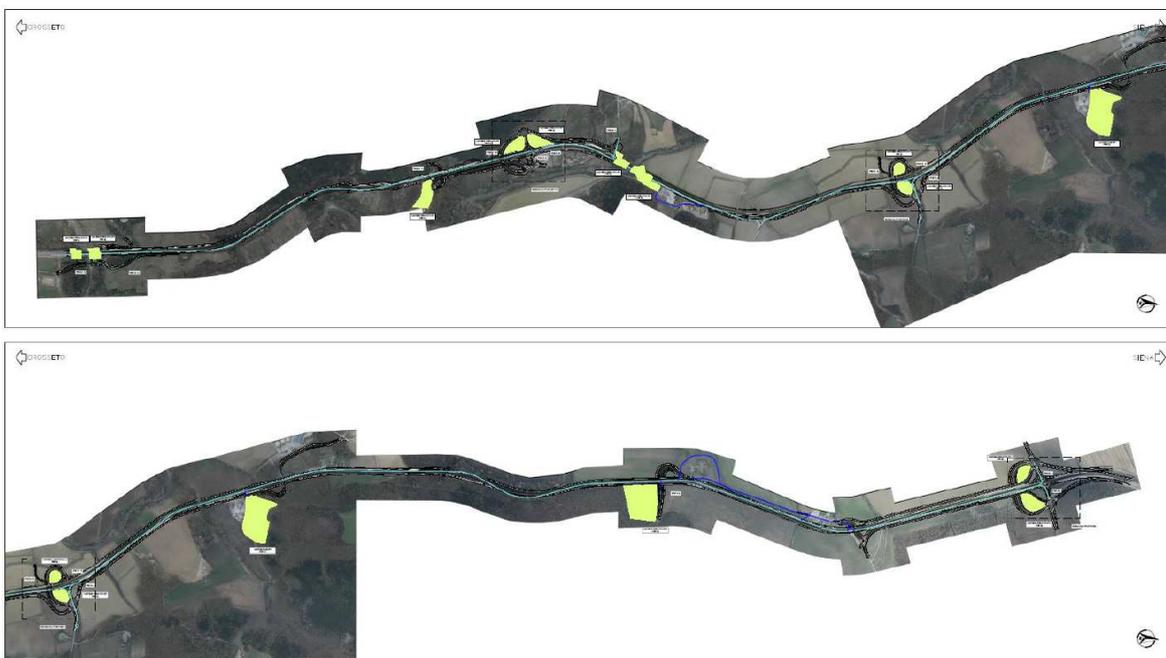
Planimetria con individuazione dei cantieri base e operativi
